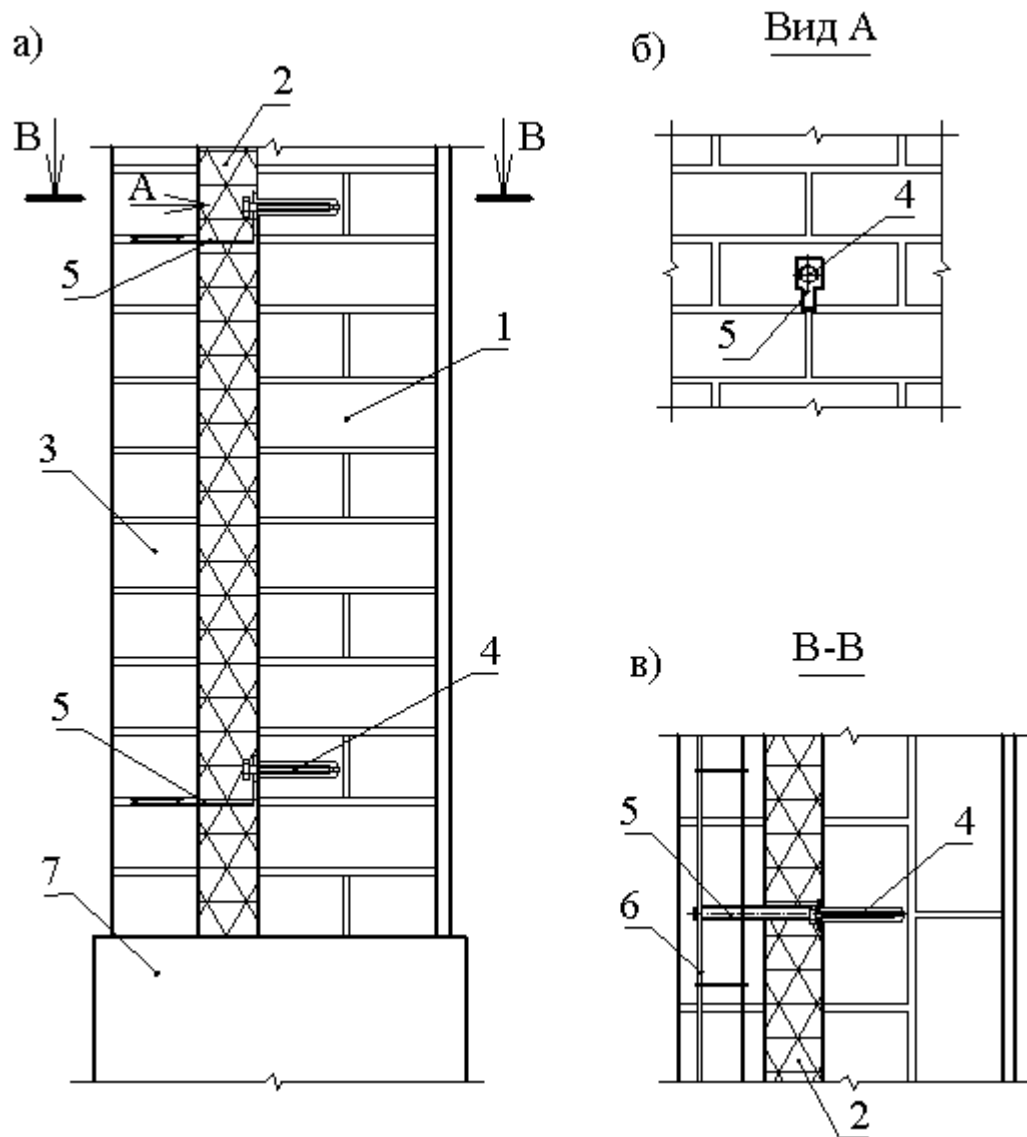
Схема наружной стены с теплоизоляцией, облицованной кирпичом
